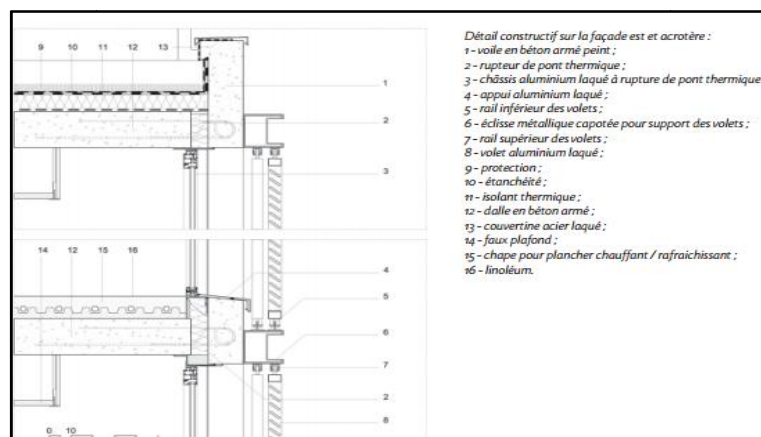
Détail constructif sur la façade est et l'acrotère (Source : Ekopolis, 2010).
